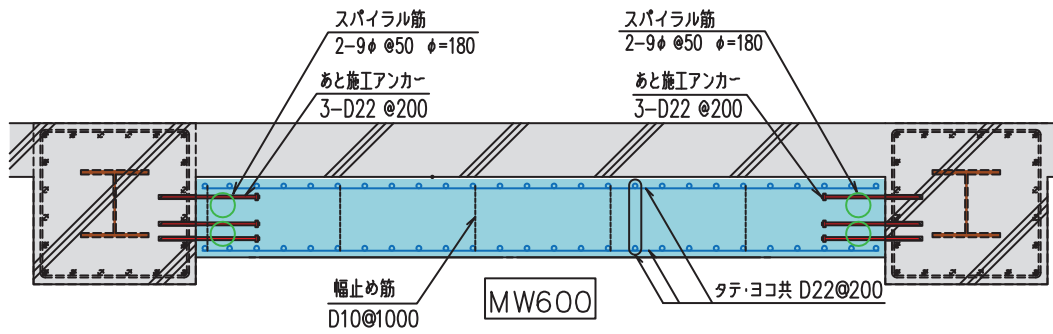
追設耐震壁配筋詳細 (B-B 断面図)
